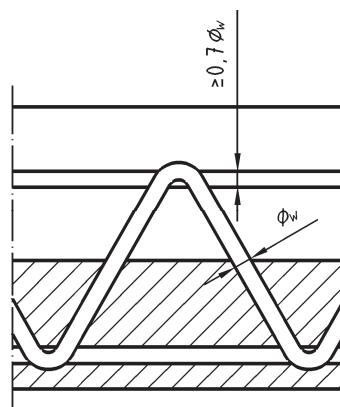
Schlaufe und Schweißverbindungen
